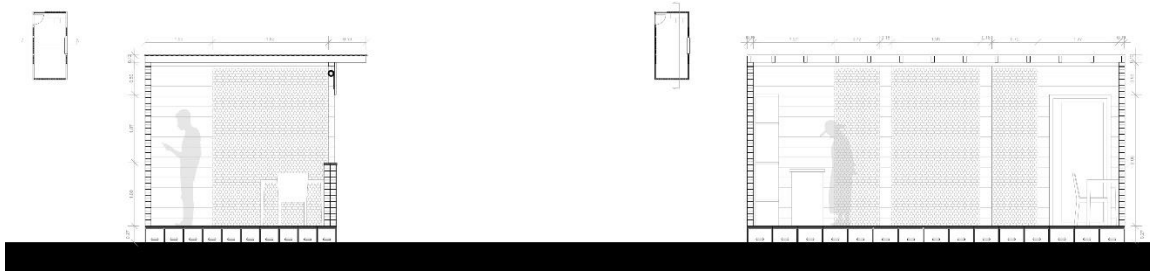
Sección transversal y longitudinal. Fuente. Elaboración propia.
